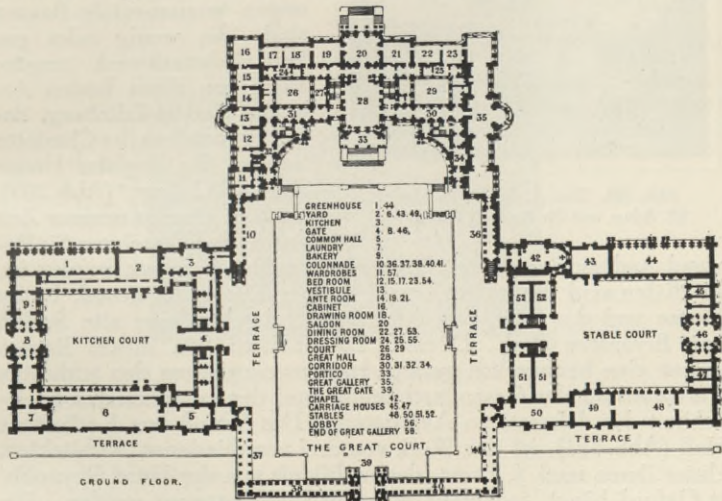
Schloß Blenheim, Grundriß. (Vanbrugh.)
